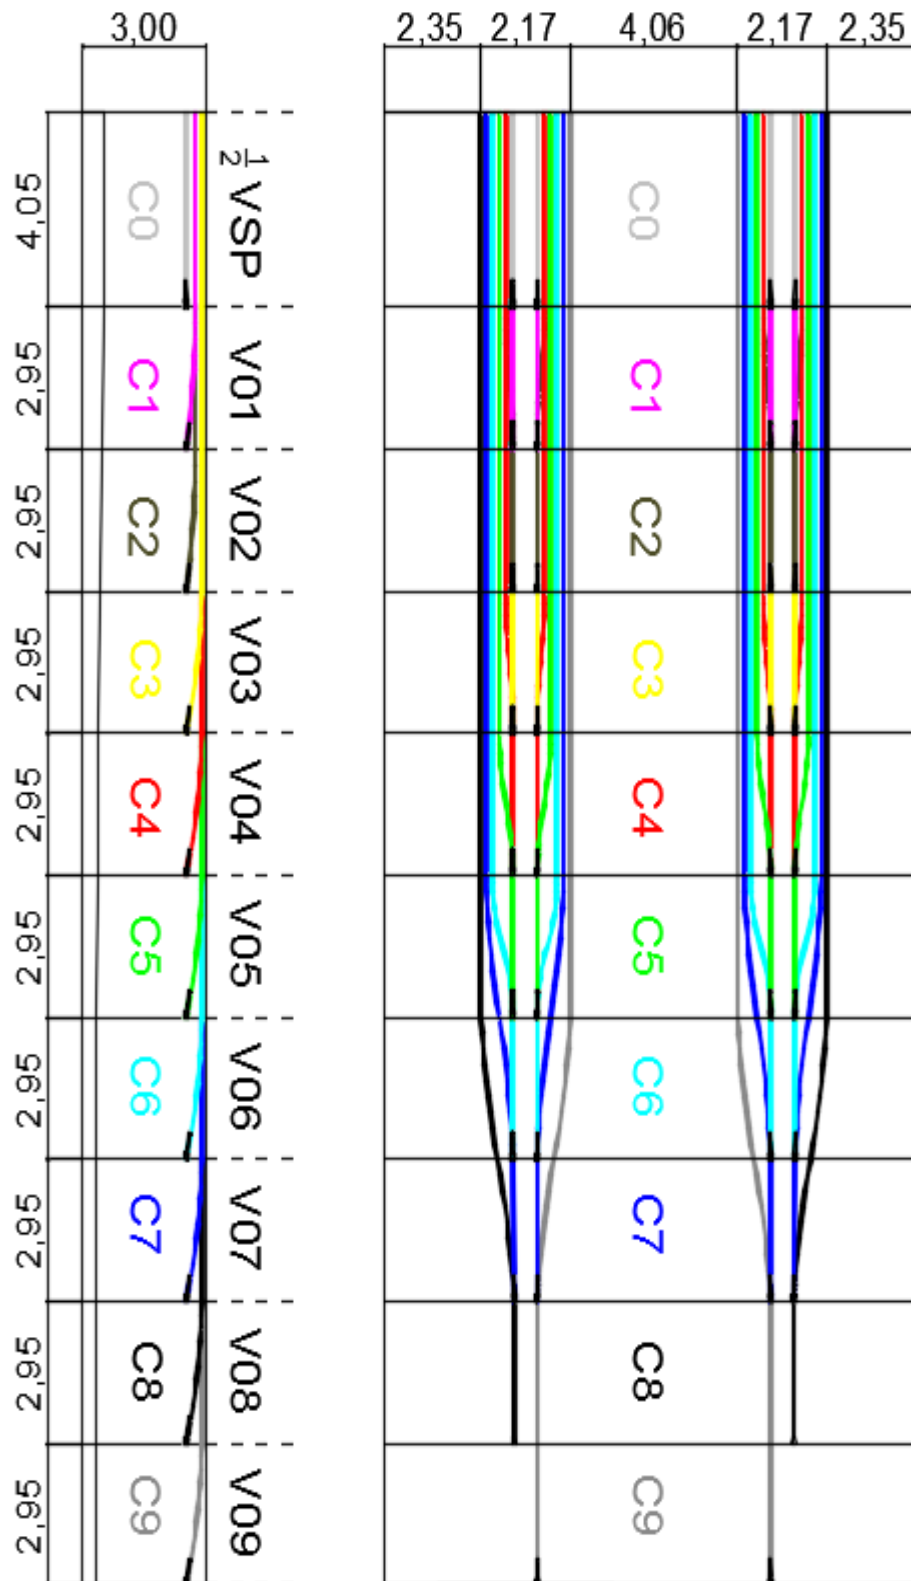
Tracé en élévation et en plan des câbles des fléaux.
